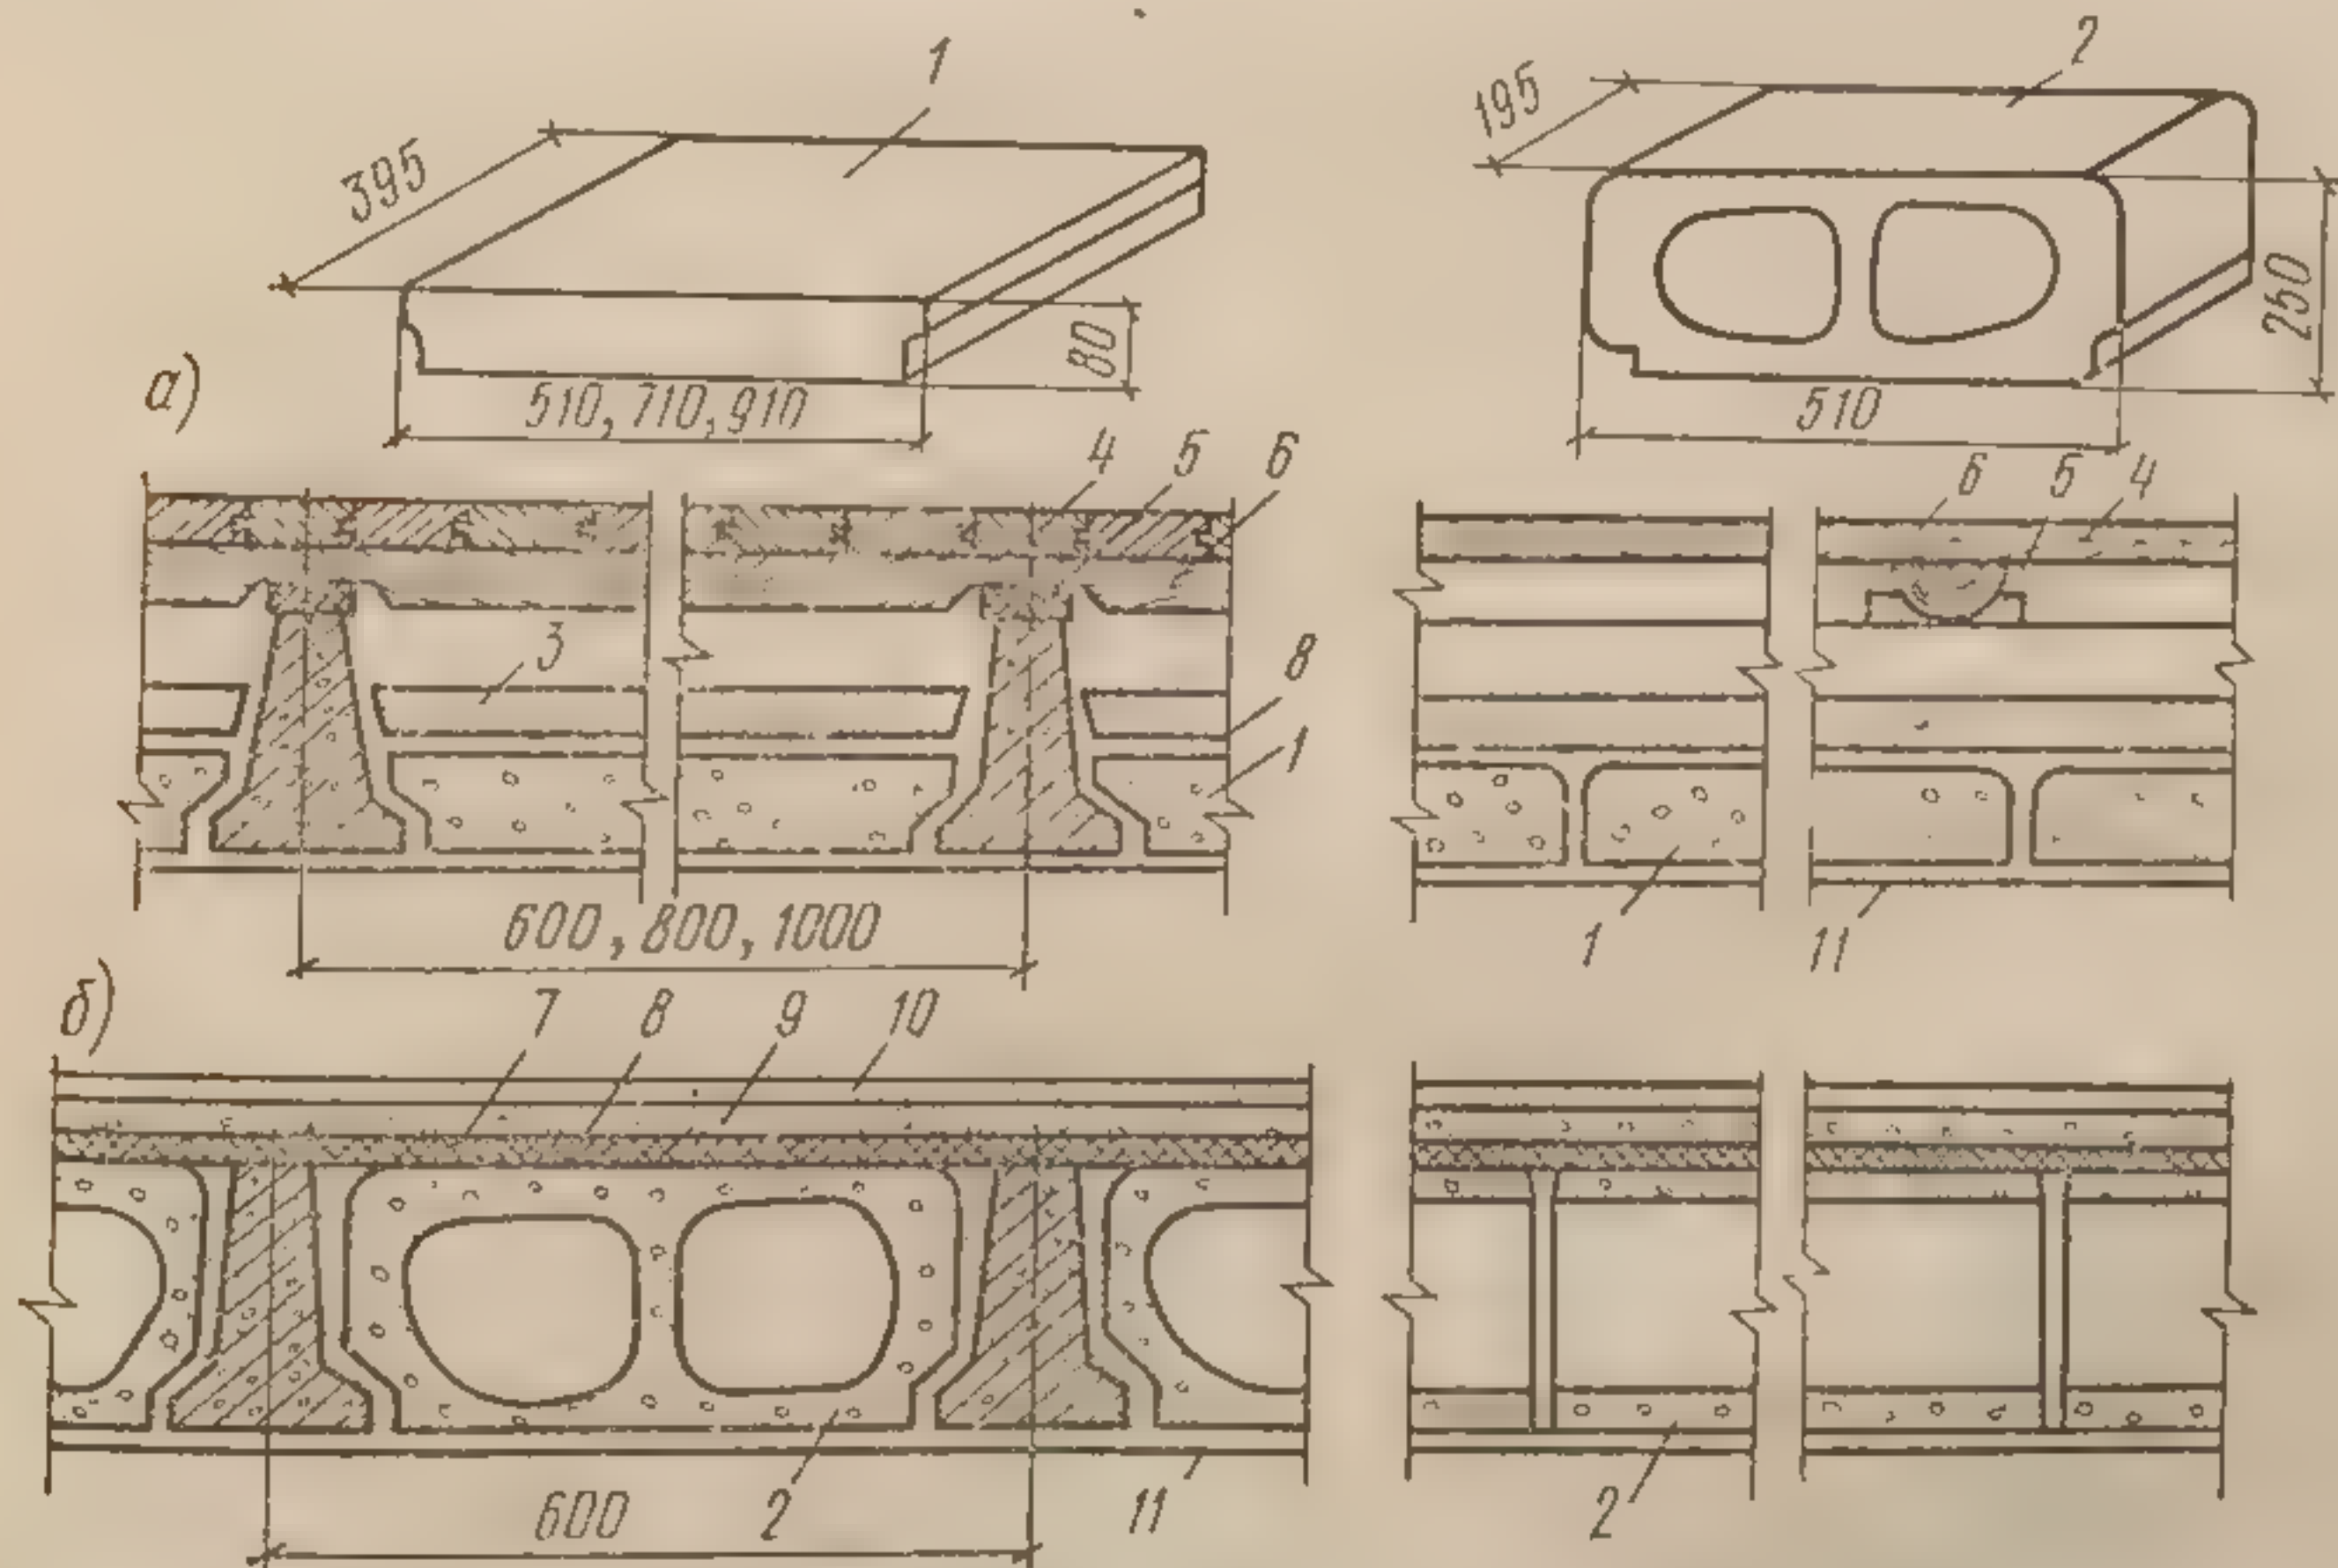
Междуэтажные перекрытия по сборным железобетонным балкам:
